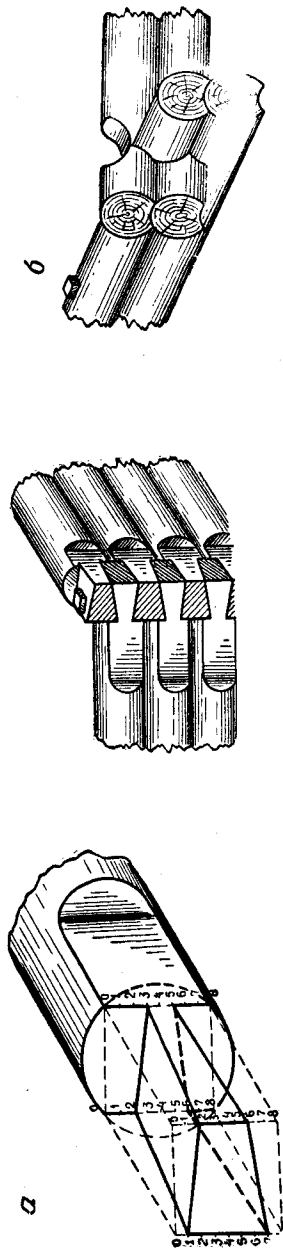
Сопряжение бревен в углах стен ряжа:
